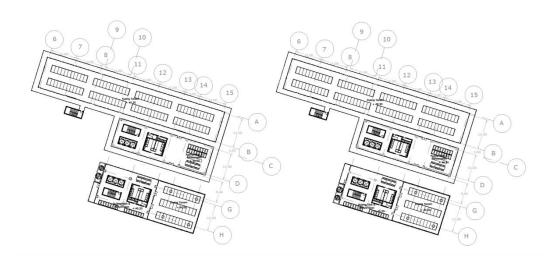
(f) Denah Lantai 6 dan 7 Tipikal
